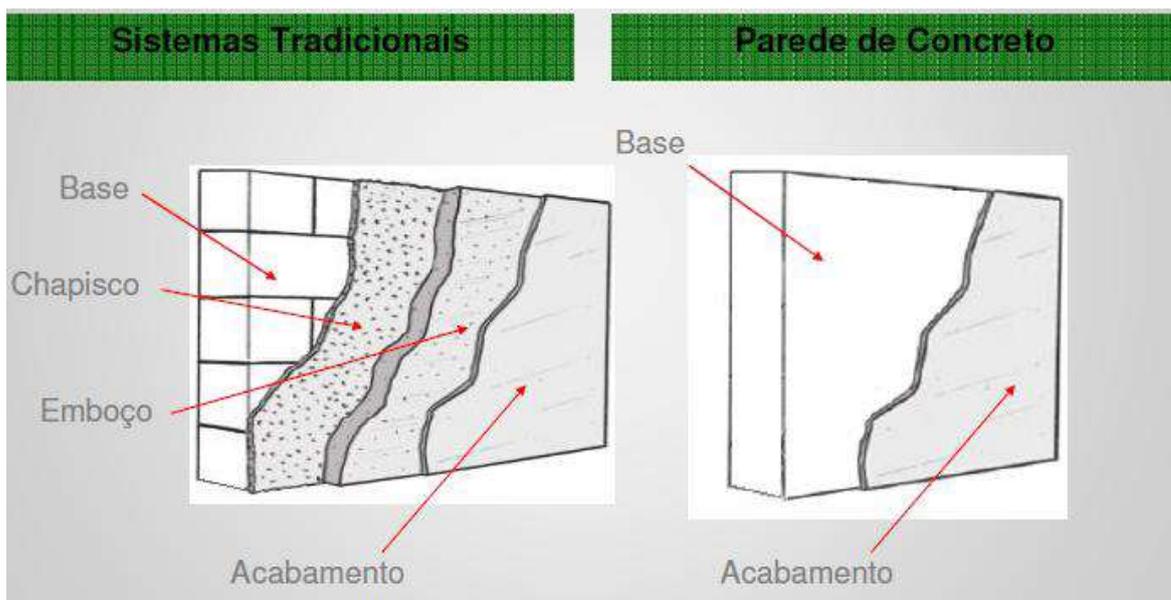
Acabamento em alvenaria estrutural e em Paredes de Concreto
